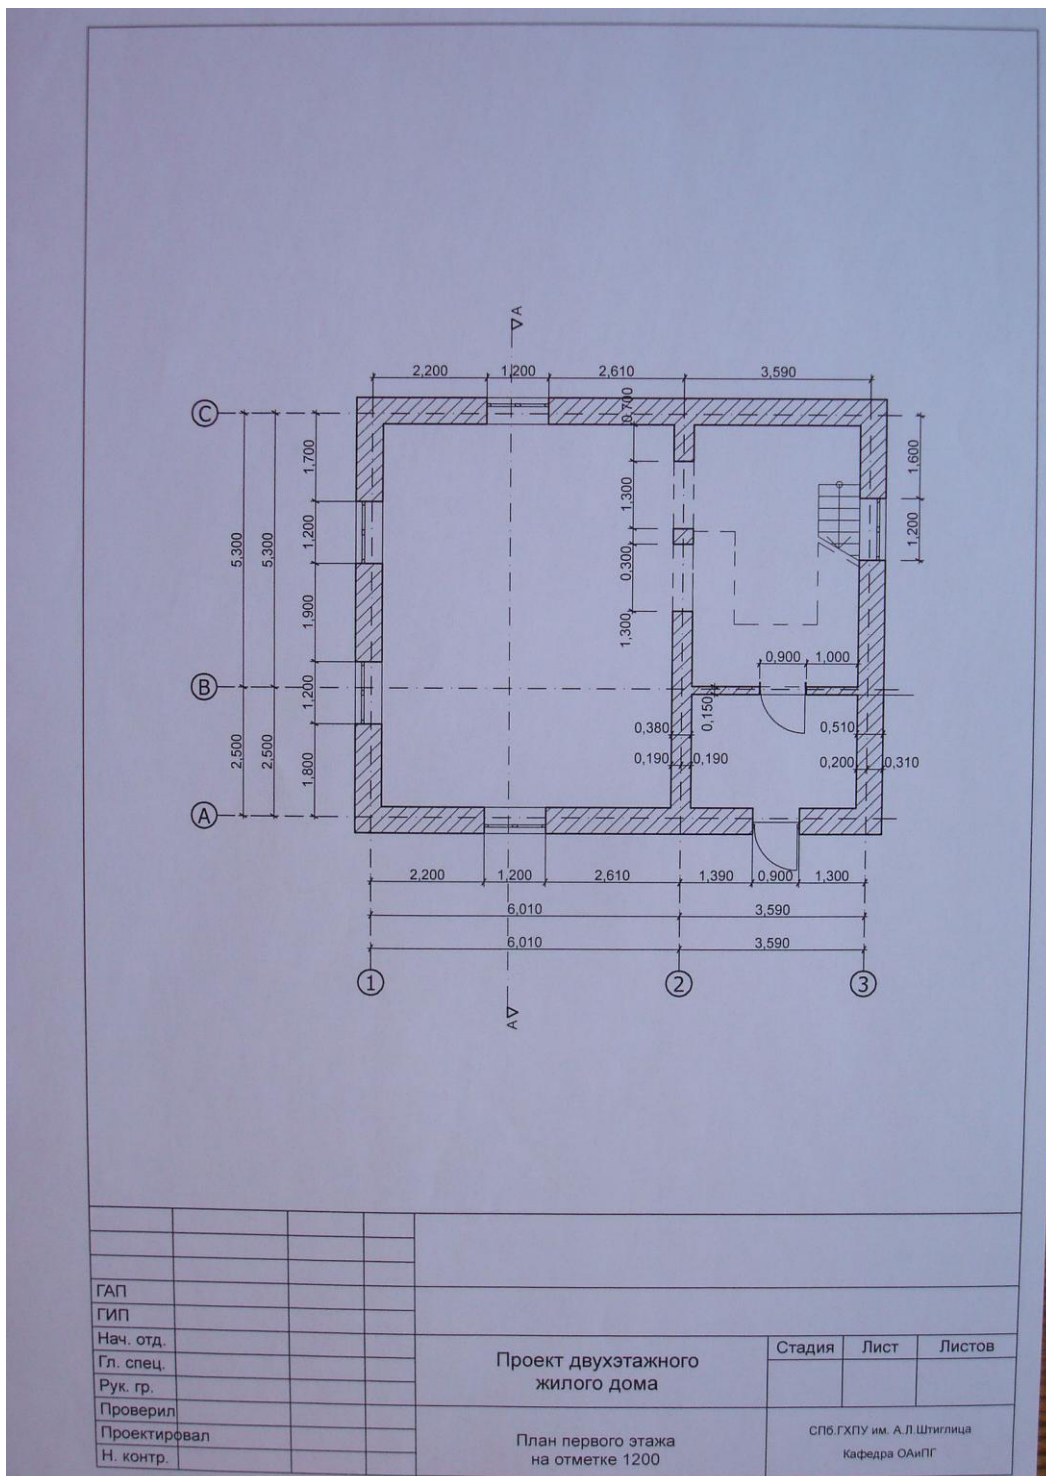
План первого этажа с размерами и строительными осями. Штамп может быть другого вида.
